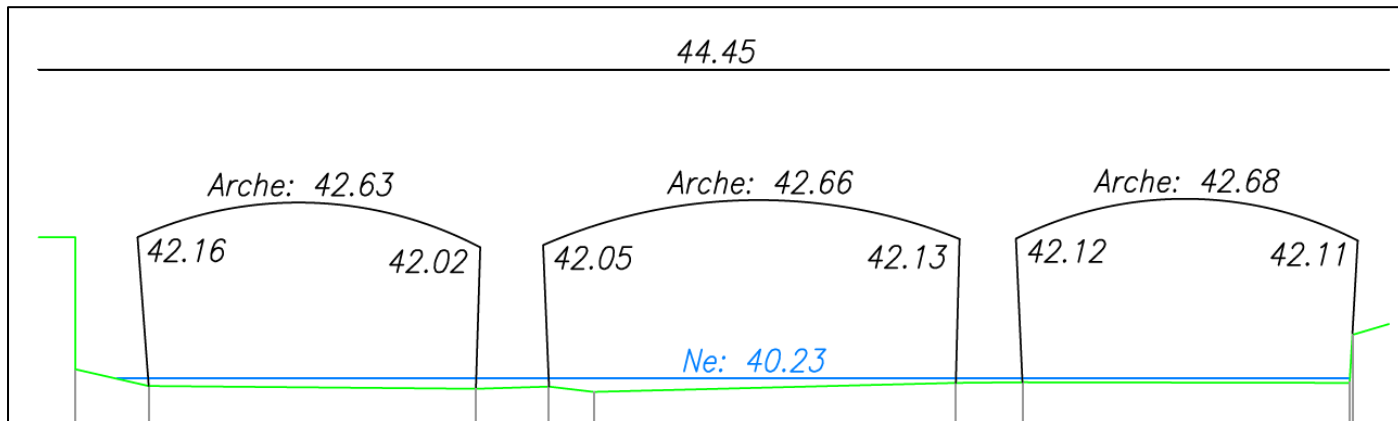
Coupe en travers du pont de la rue des Fabriques
